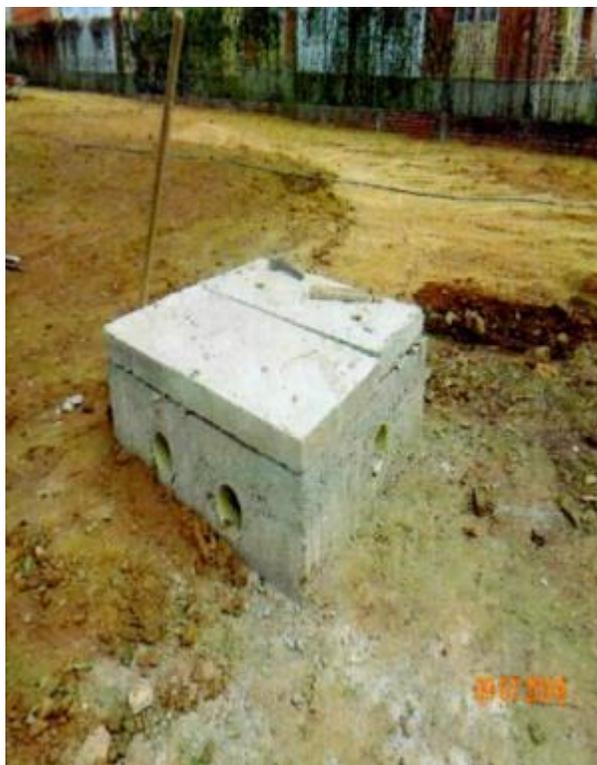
Construcción cajas de inspección en concreto (4/4).
